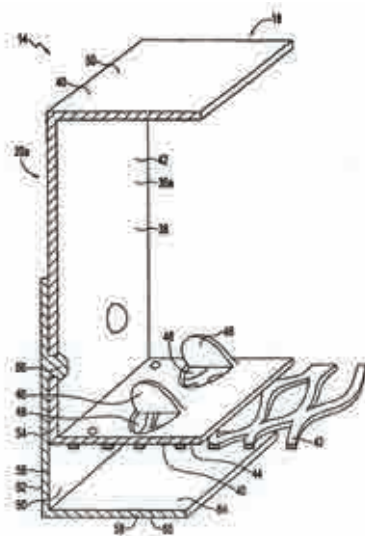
Sección tipo de la solución del perfil de borde perimetral del sistema Ecoliteconcrete
